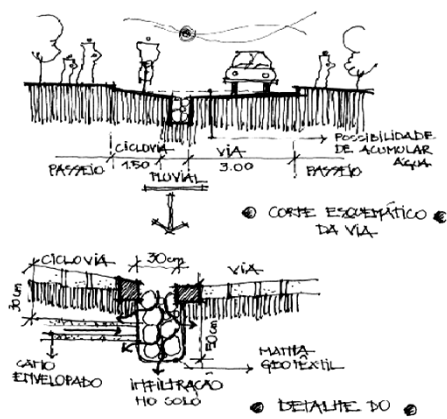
Perfil da rua e detalhe do sistema pluvial
